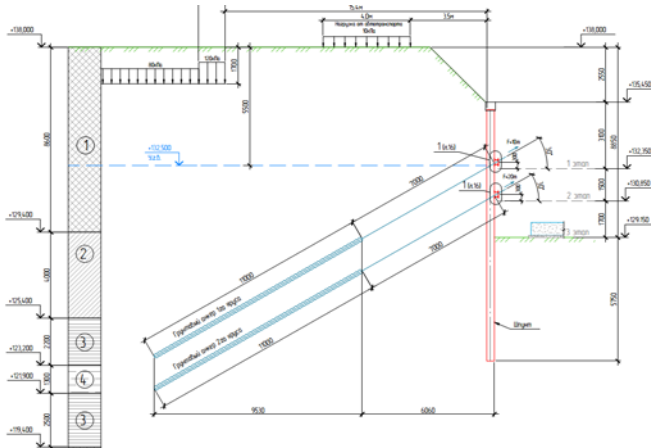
Устройство ограждения котлована с применением грунтовых анкеров
